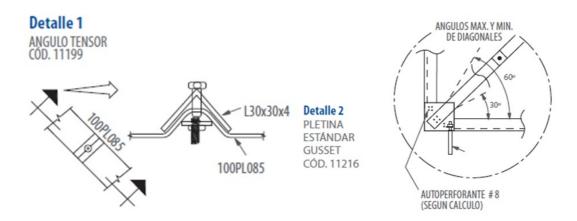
Croquis de arriostre y detalles ángulo tensor y pletinas
